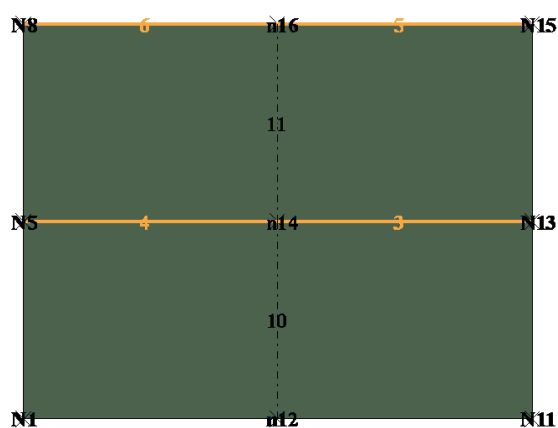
Prospetto Parete 2 - Modello Scollegato
